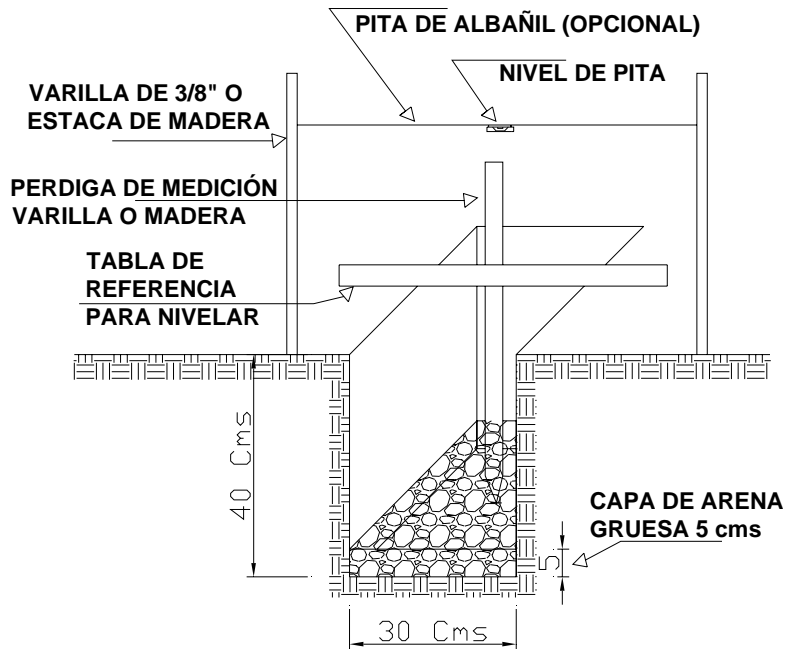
SECCIÓN TRANSVERSAL DE POZO TERMINADO.
